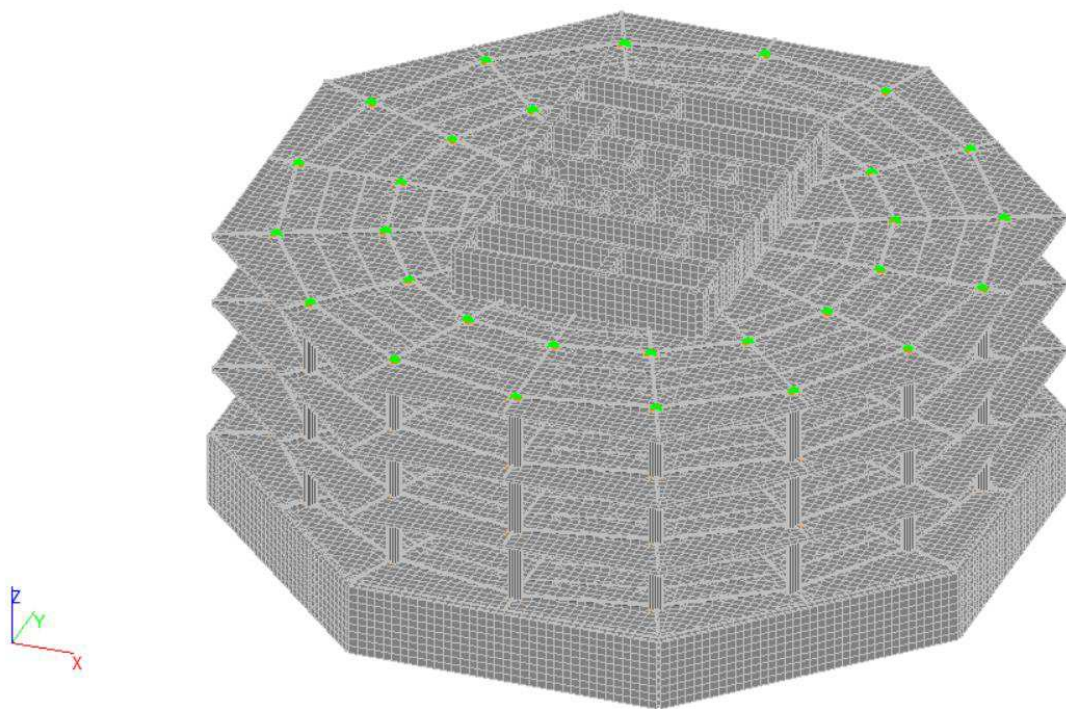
Фрагмент расчетной схемы в ПК SCAD
